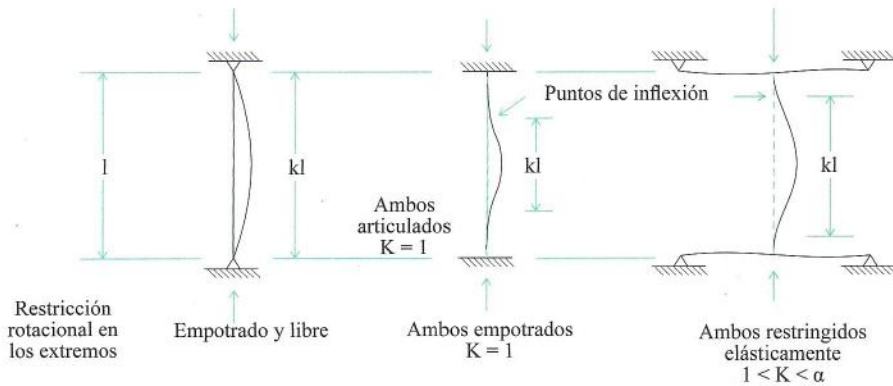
Longitud efectiva de columnas con desplazamiento lateral permitido
